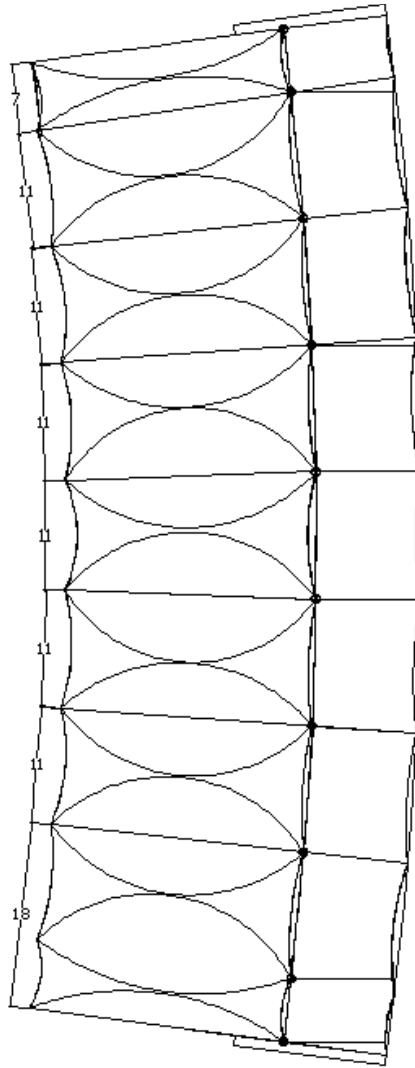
Vista en corte de la cubierta (*Elaboración propia*).
